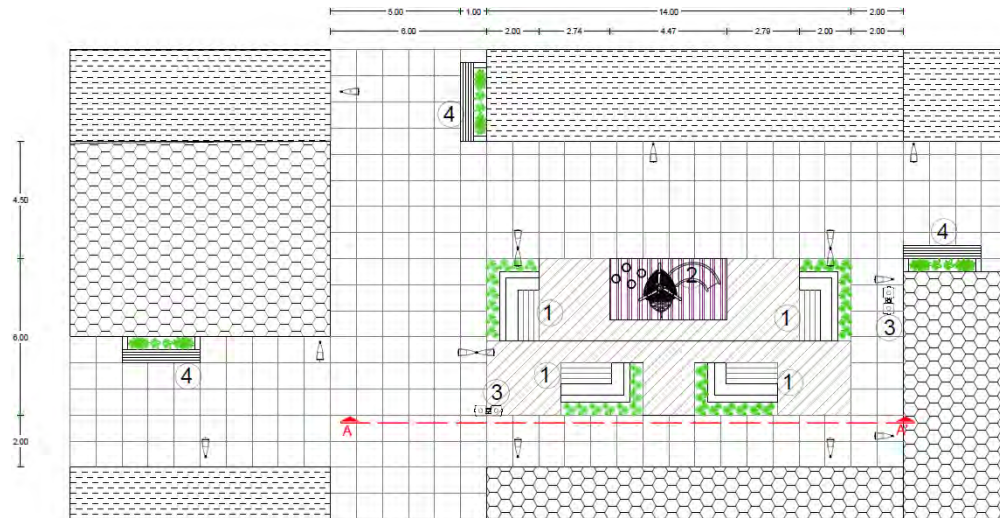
Planta arquitectónica de la plaza 11. Se ve la distribución del mobiliario ocupado y el cambio de piso.
